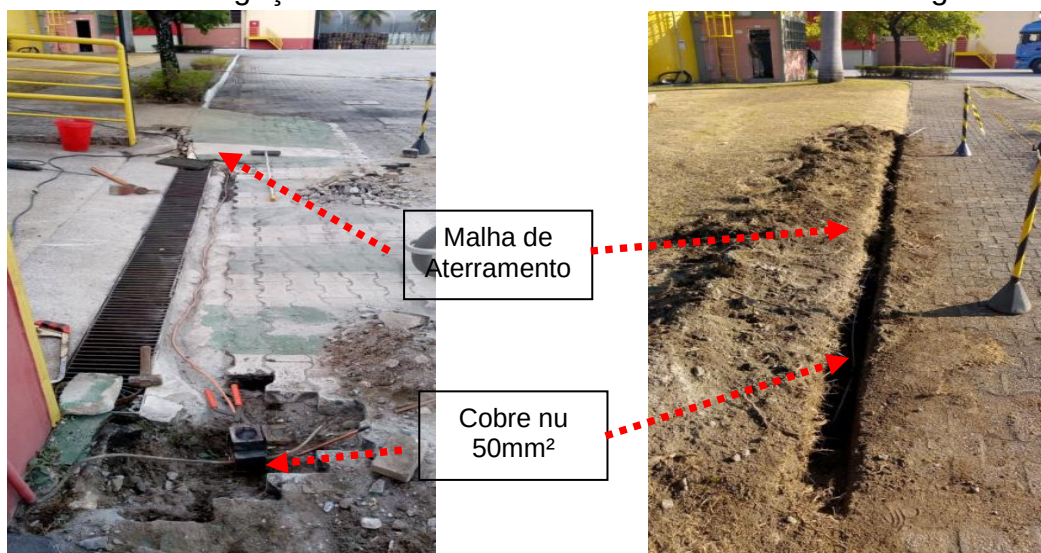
e 205: Sistema de aterramento como construído/ Revitalização das conexões
